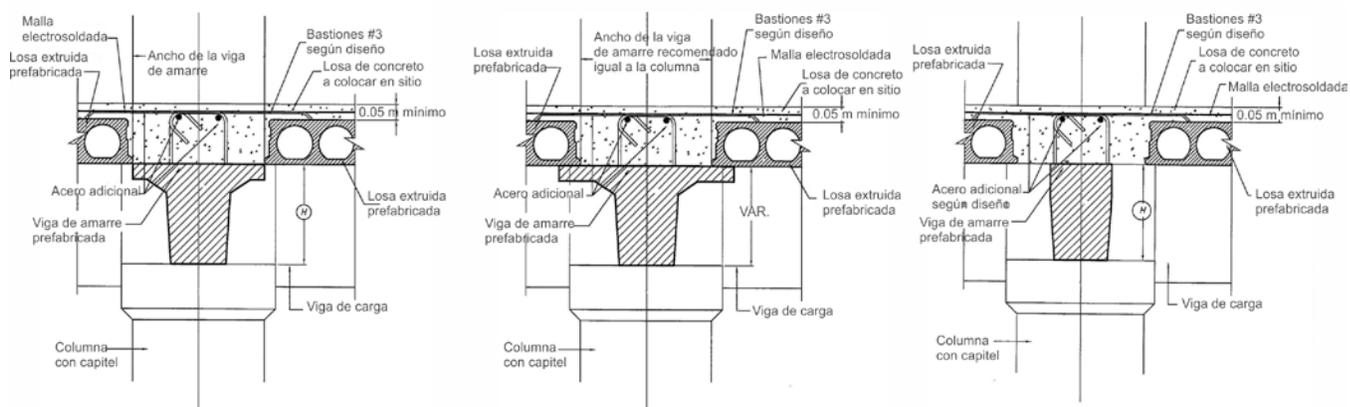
Secciones C-C, opciones 1, 2 y 3 de conexión viga de amarre central - entrepiso
